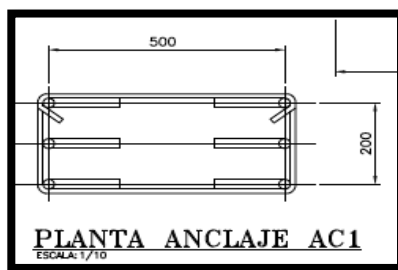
Planta de Anclaje ODR Ingeniería y Montajes
